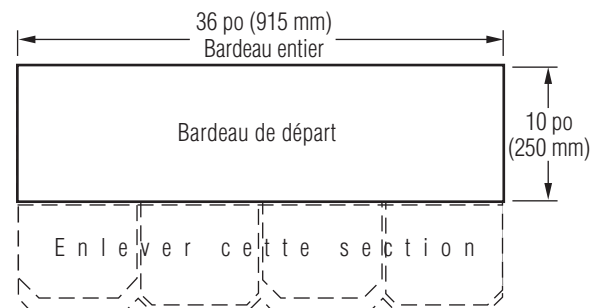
Fabriquer les bardeaux de départ en enlevant 8 po (203 mm) au bas des jupes.
